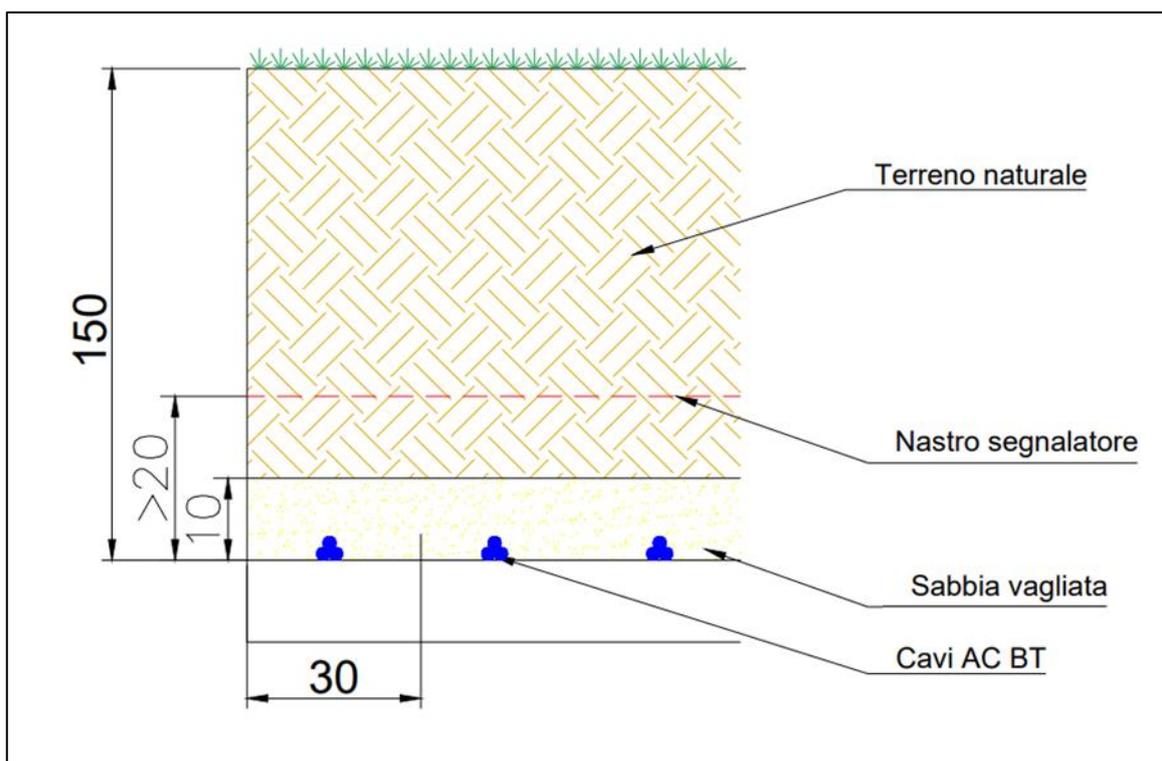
Cavi Bassa Tensione – Sezione 2 cavo multiplo
